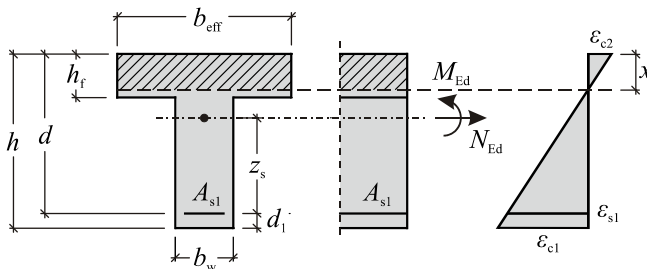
Bezeichnungen am Plattenbalkenquerschnitt
